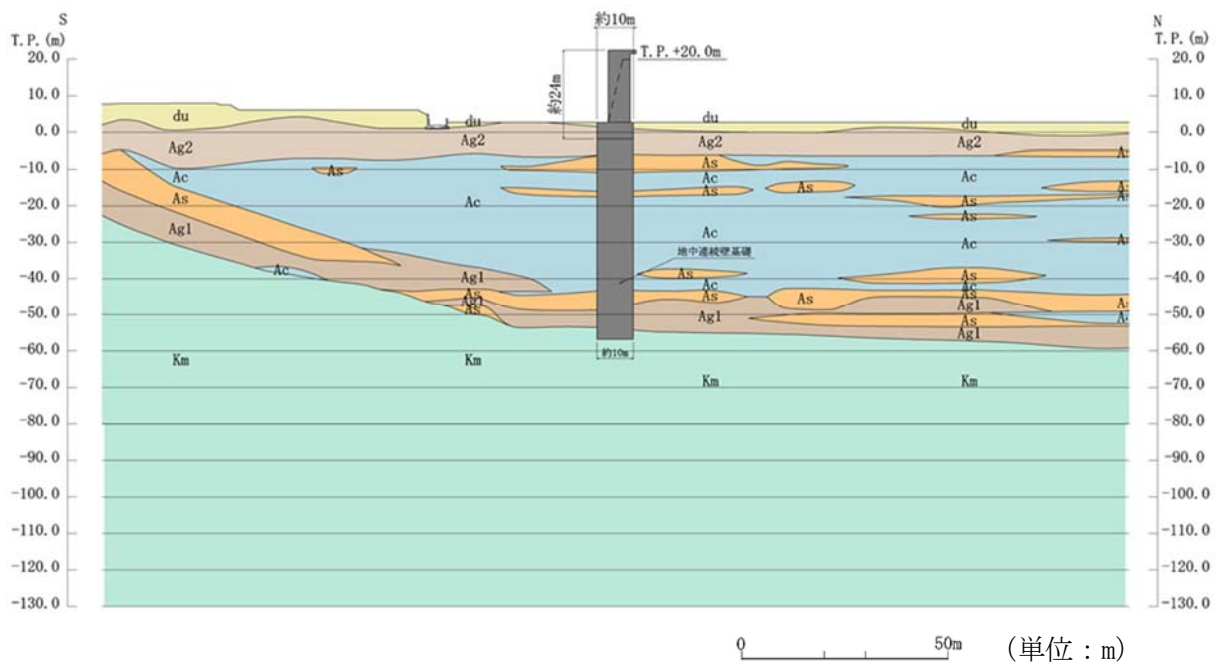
(1) 鉄筋コンクリート防潮壁 評価対象断面図 (①-①断面)
